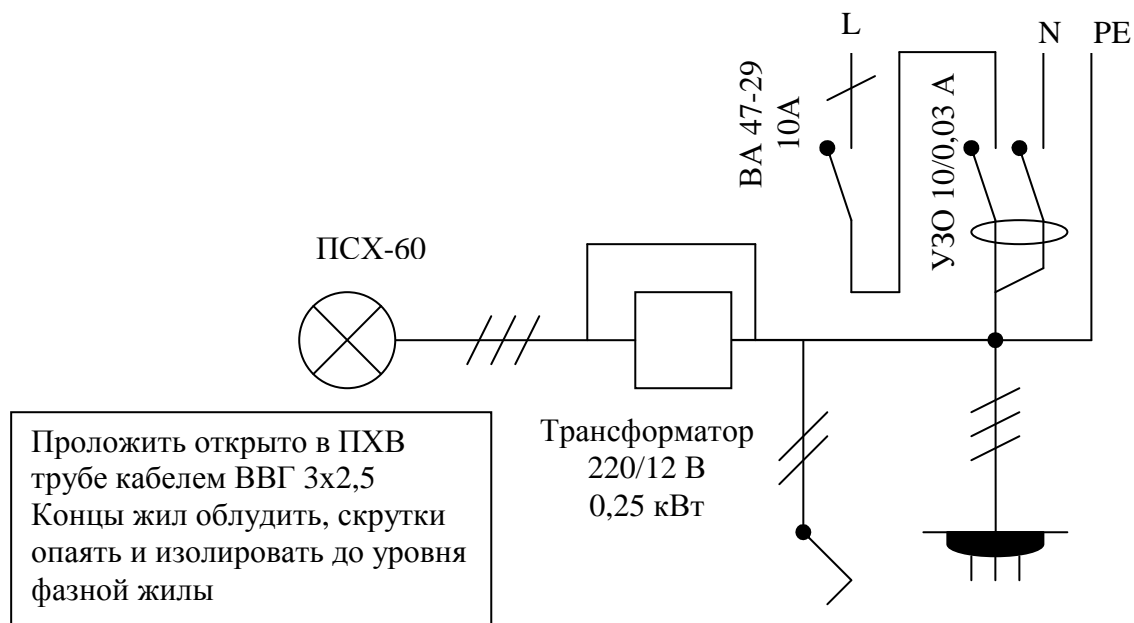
Монтажная схема электропроводки в сырых и влажных помещениях.
